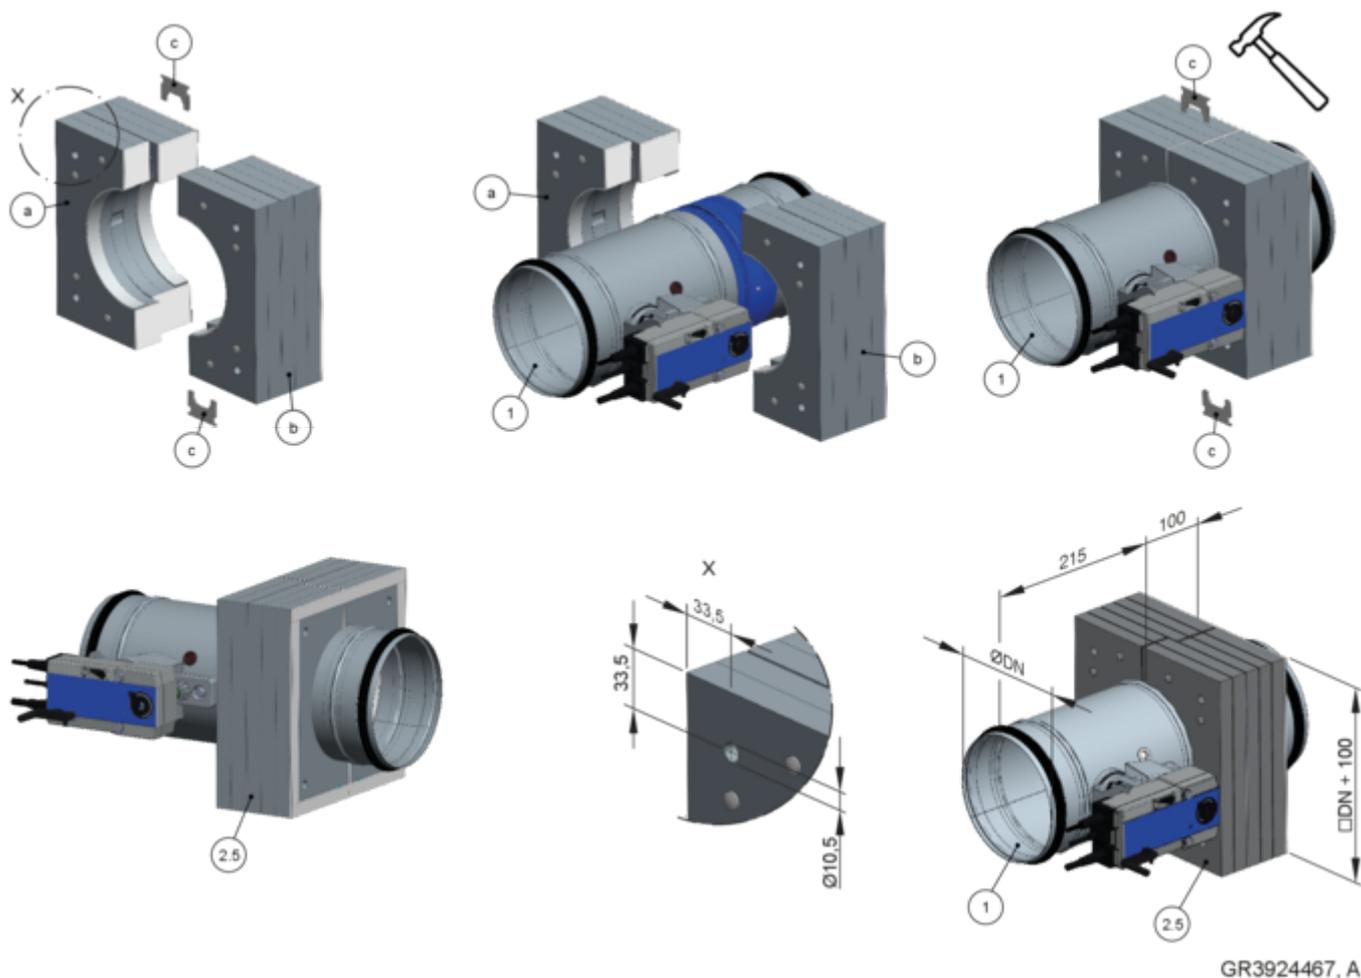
Lieferumfang und Montage Einbausatz WA2 für Trockeneinbau
